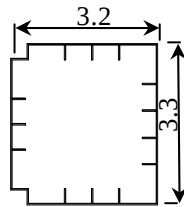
塔柱横断面図 (単位: m) 図-3 三次元骨組(Fish-bone)モデル
